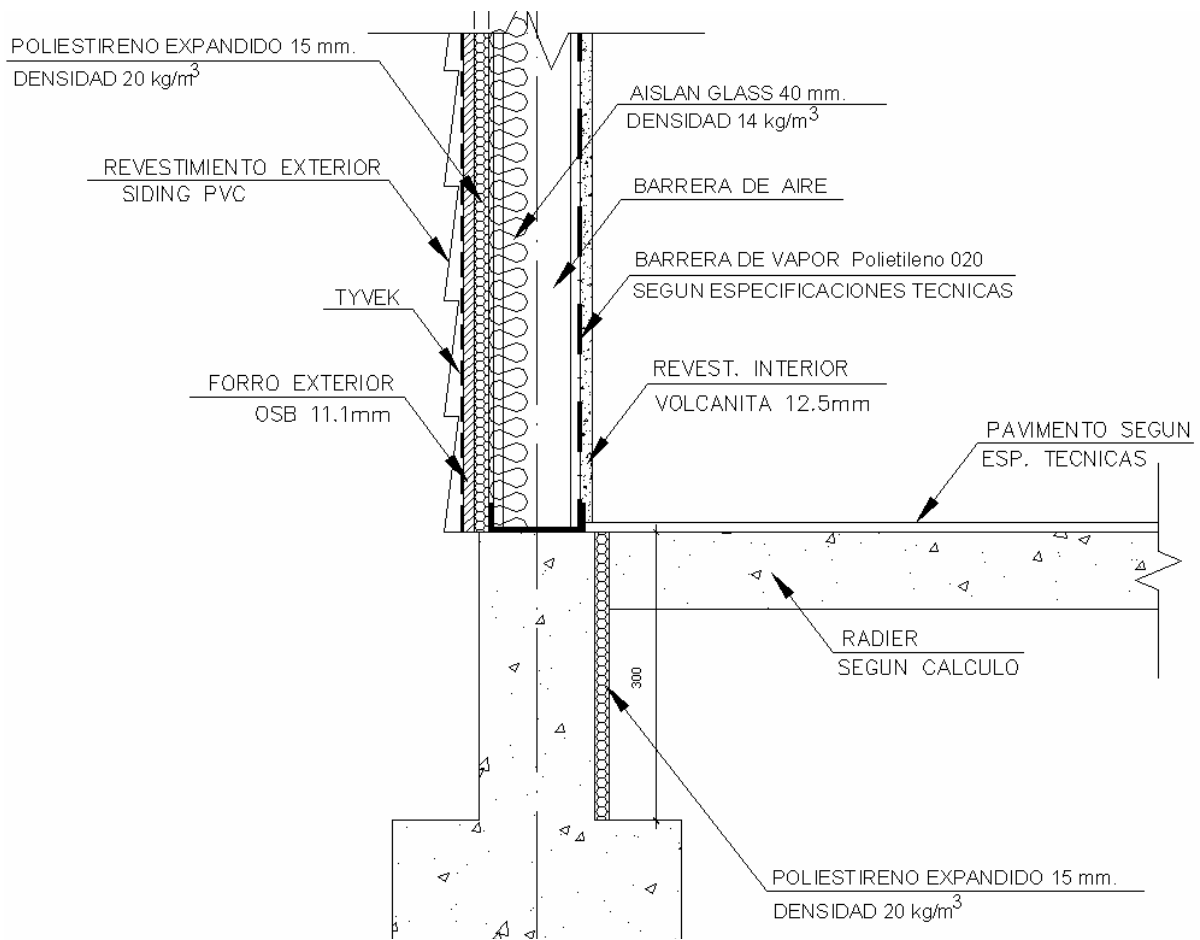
Sistemas de Aislamiento Térmico del Muro Perimetral y Piso de las viviendas.
